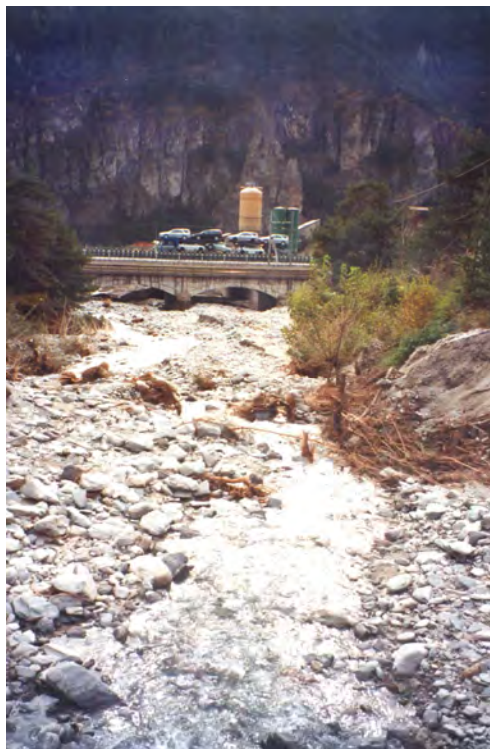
Salbertrand - Vista ponte FS a valle del ponte SS 24 sul Rio ...
